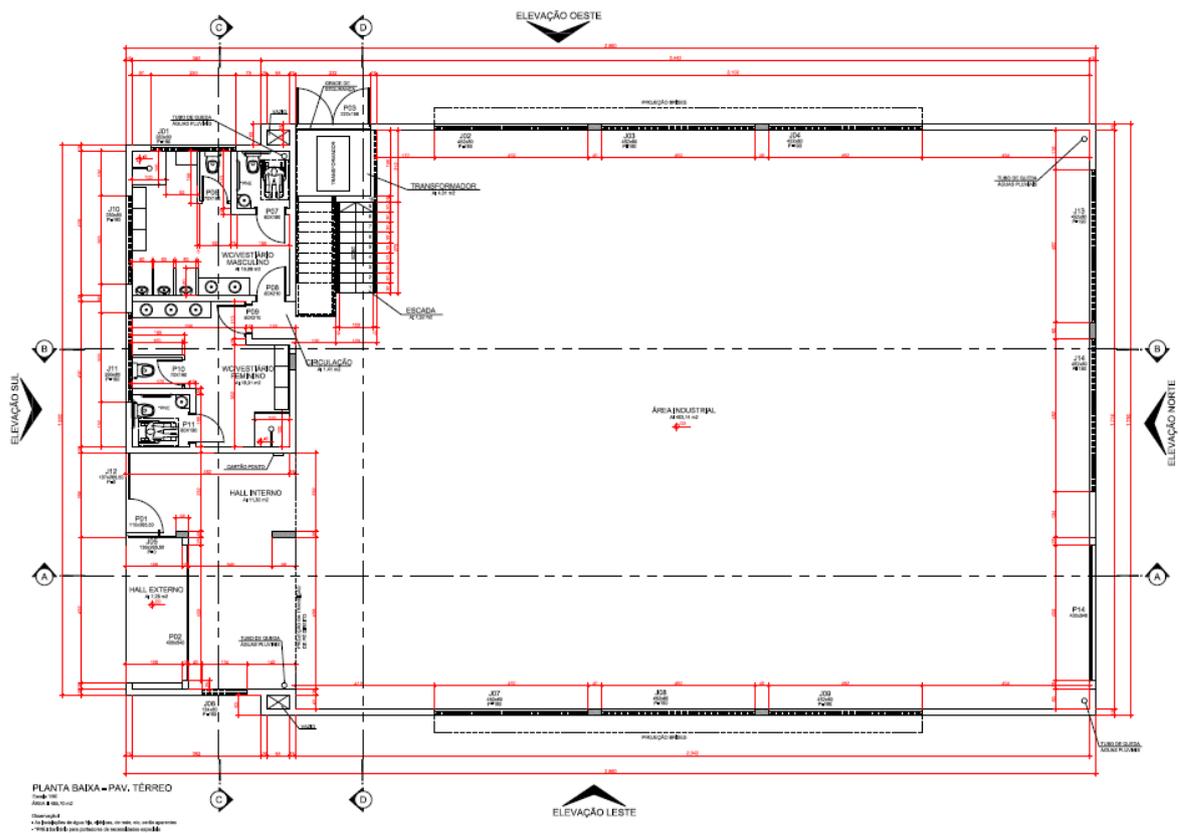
Planta baixa – pav. Térreo – área 495,70m<sup>2</sup>
